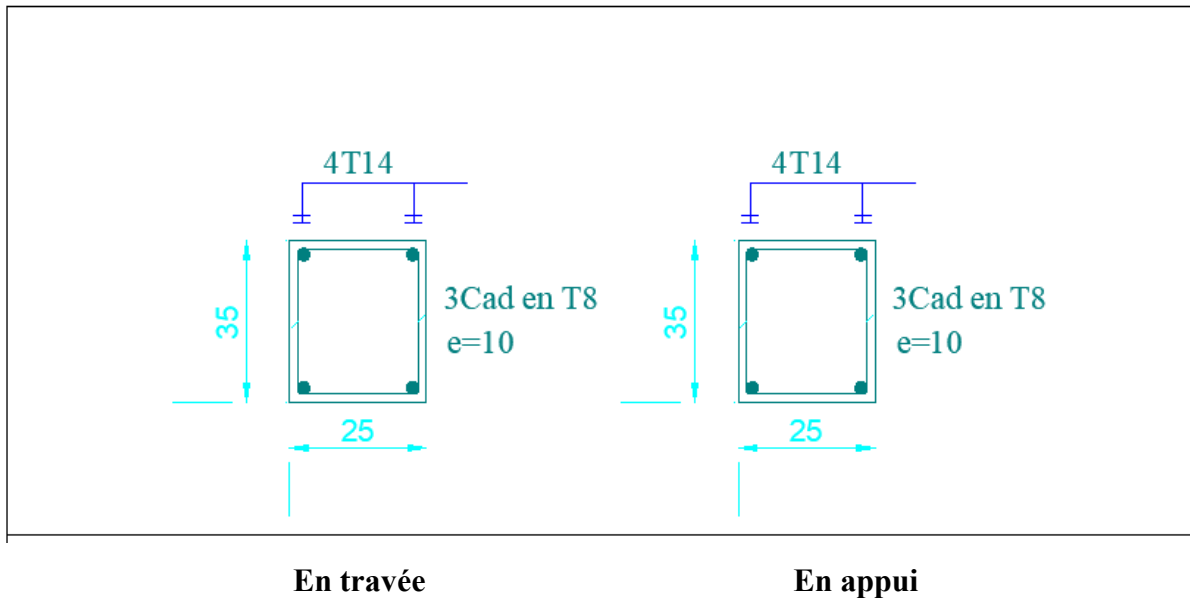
Schéma de ferrailage de poutre secondaire
